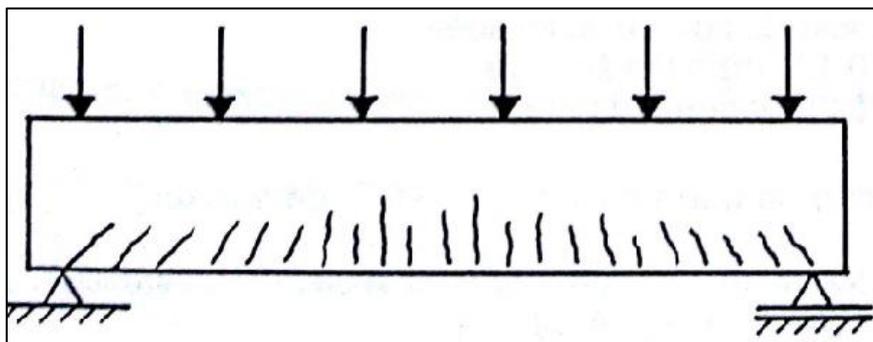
Fissuração típica em viga subarmada solicitada à flexão.
